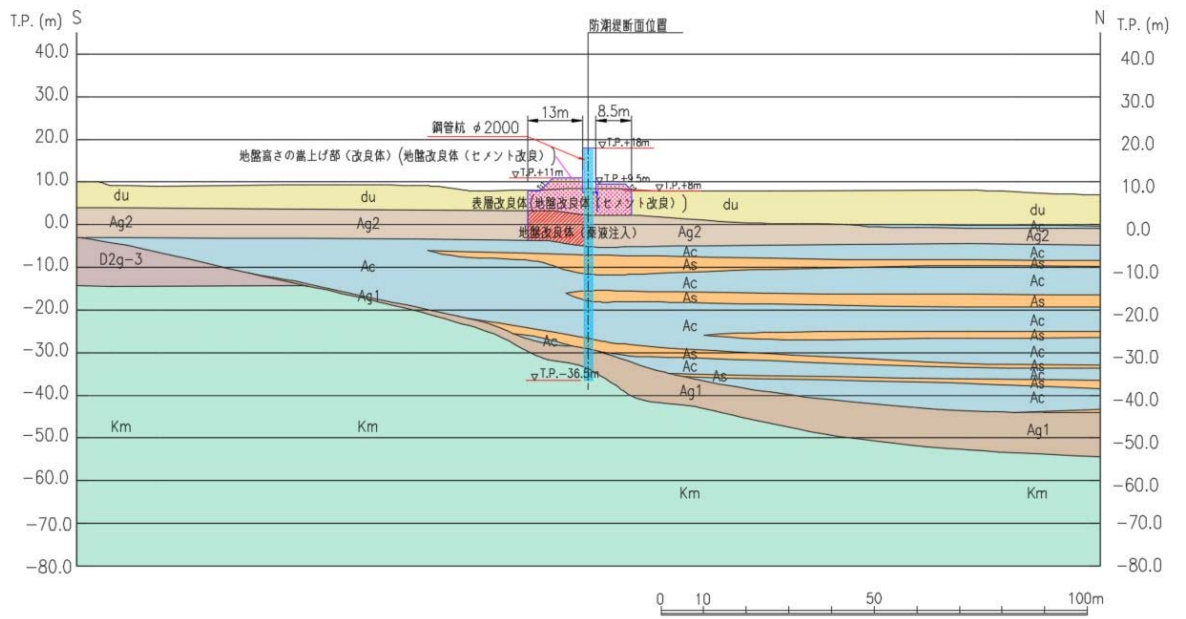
地震応答解析対象断面図 (断面⑤)
